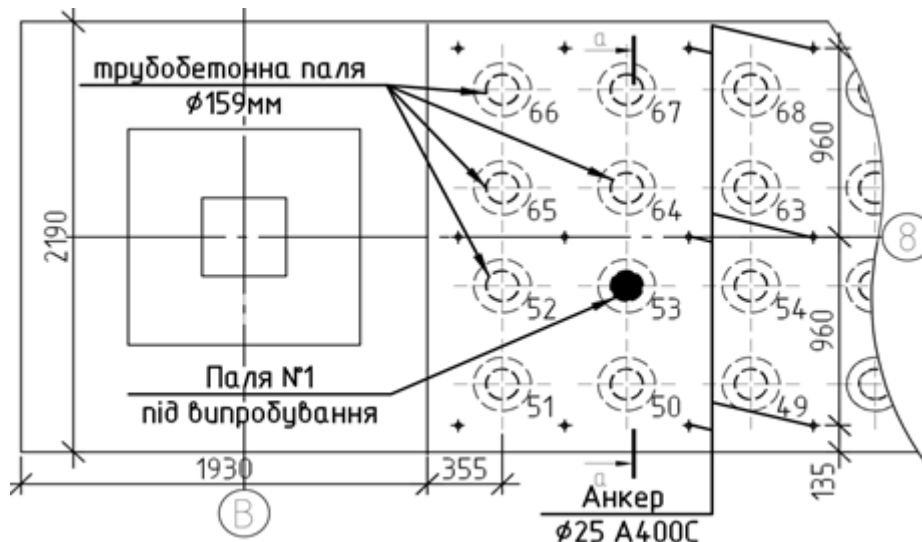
Фрагмент схеми фундаменту під діафрагму
